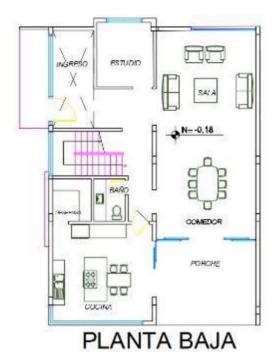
Casa 1 - planta baja Elaborado por: Carolina Calupiña M
